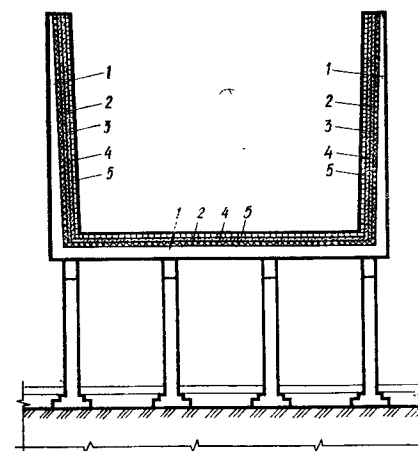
Гидроизоляция ванн плавательных бассейнов:
